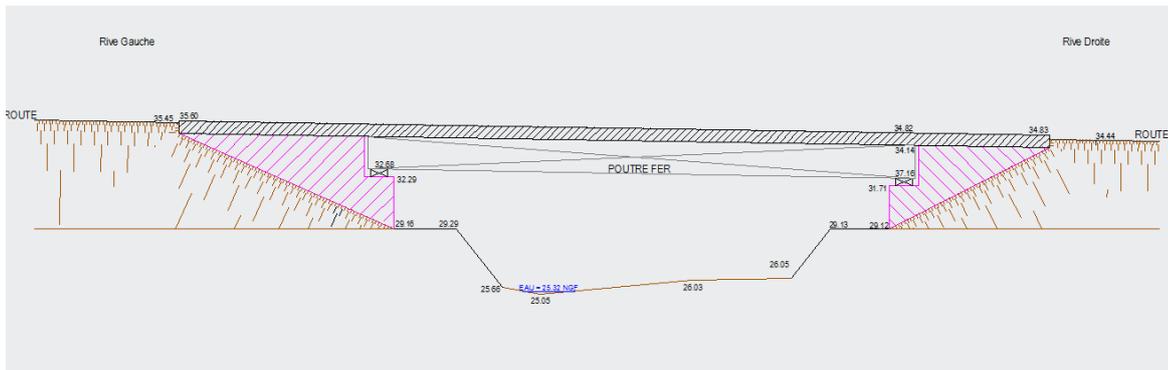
COUPE DE L'OUVRAGE DE FRANCHISSEMENT DE LA MOSSON PAR LA RN109
